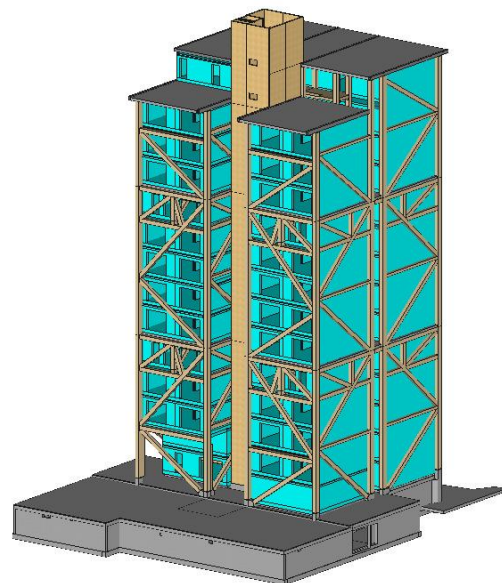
Systèmes constructifs pour la grande hauteur testés sur des projets concrets
